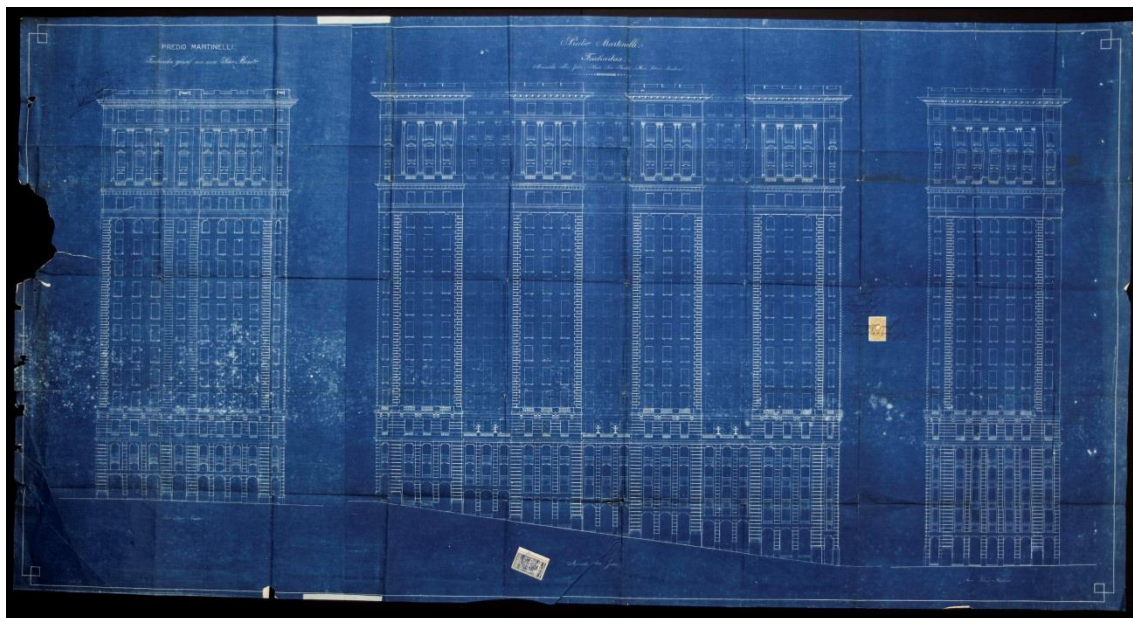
Desenho das três fachadas: Rua São Bento; Avenida São João; Rua Líbero Badaró.
